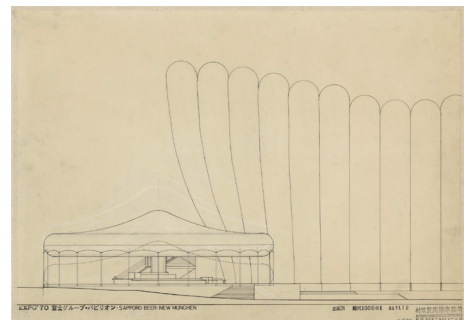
SAPPORO BEER NEW MUNCHEN 立面図 (7-13-55)
